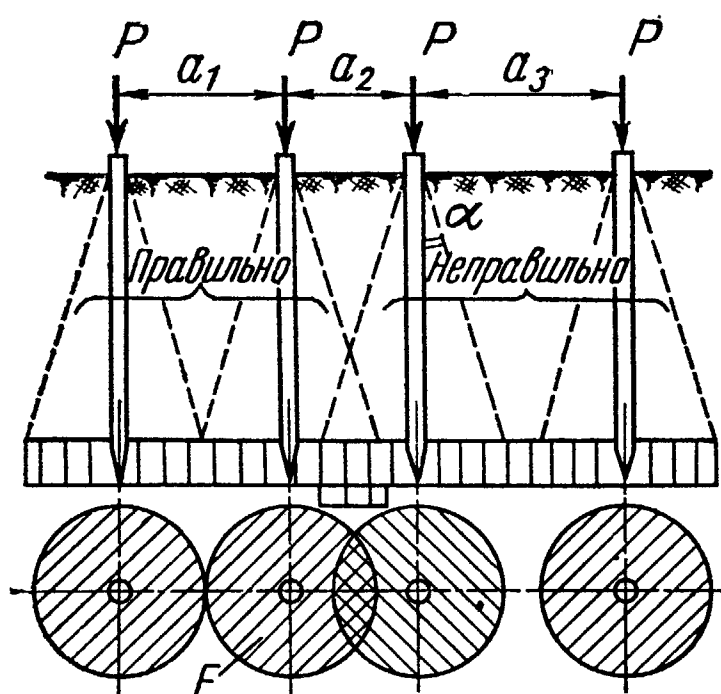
Схема напряженной зоны в грунте около свайного стержня
